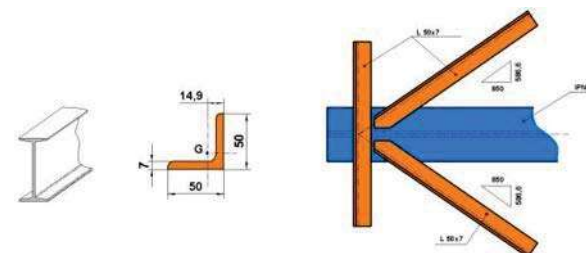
Perfiles de Acero/ Cassandra, Guía de construcción ilustrada, Editorial Limusa Wiley, 2004
